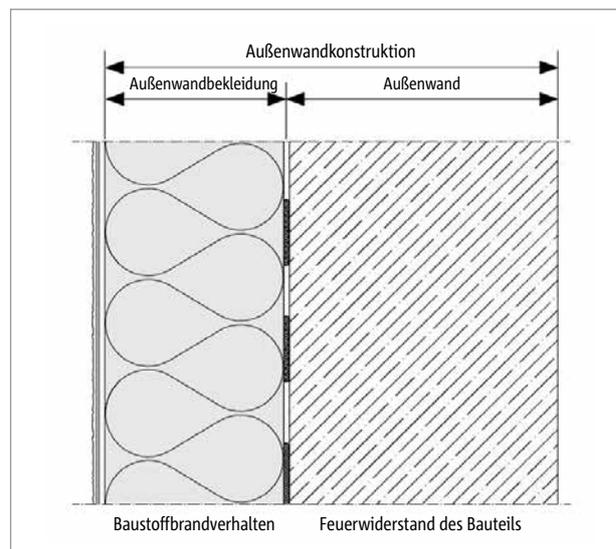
Aufbau einer Außenwandkonstruktion und deren Brandschutzanforderungen (© Fachverband WDVS/VDPM)
